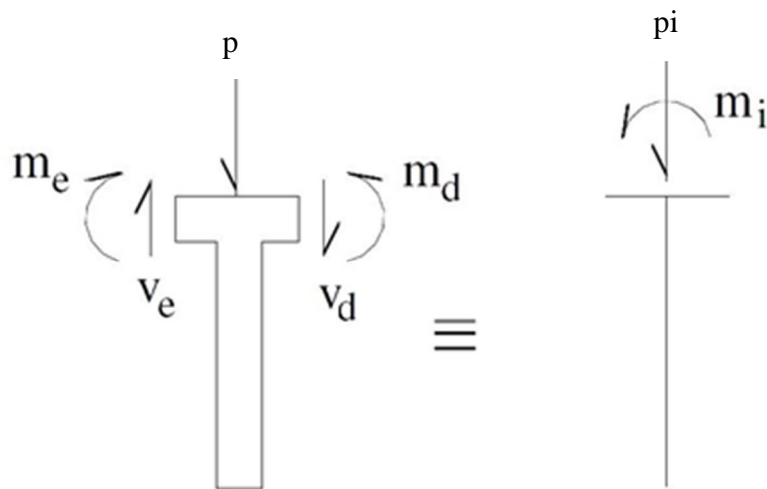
Viga isolada de uma ponte qualquer (STUCCHI, 2006)
